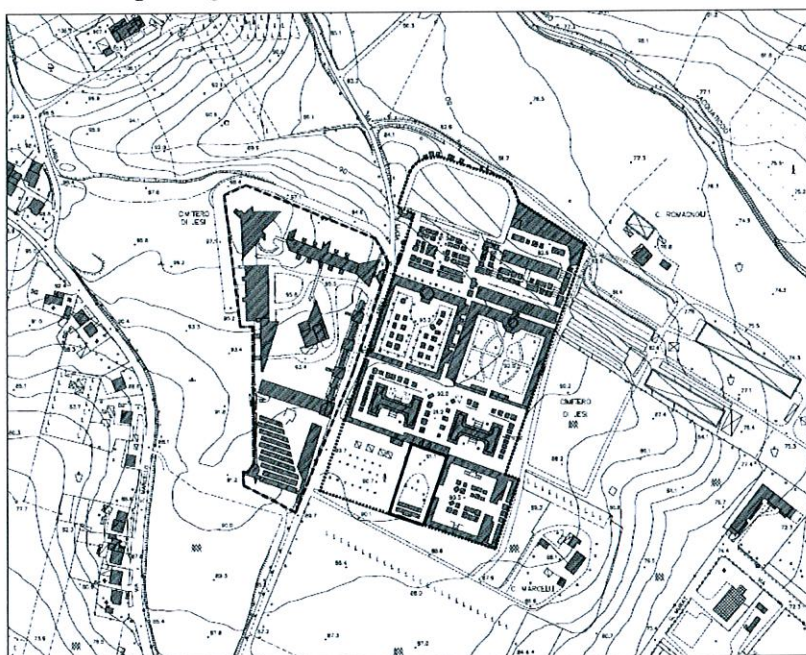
stralcio da “CTR Sezione 292070 e Sezione 292080”
